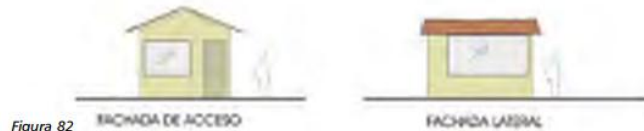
Diseño propuesto para caseta de vigilancia, SECTUR, 2004
